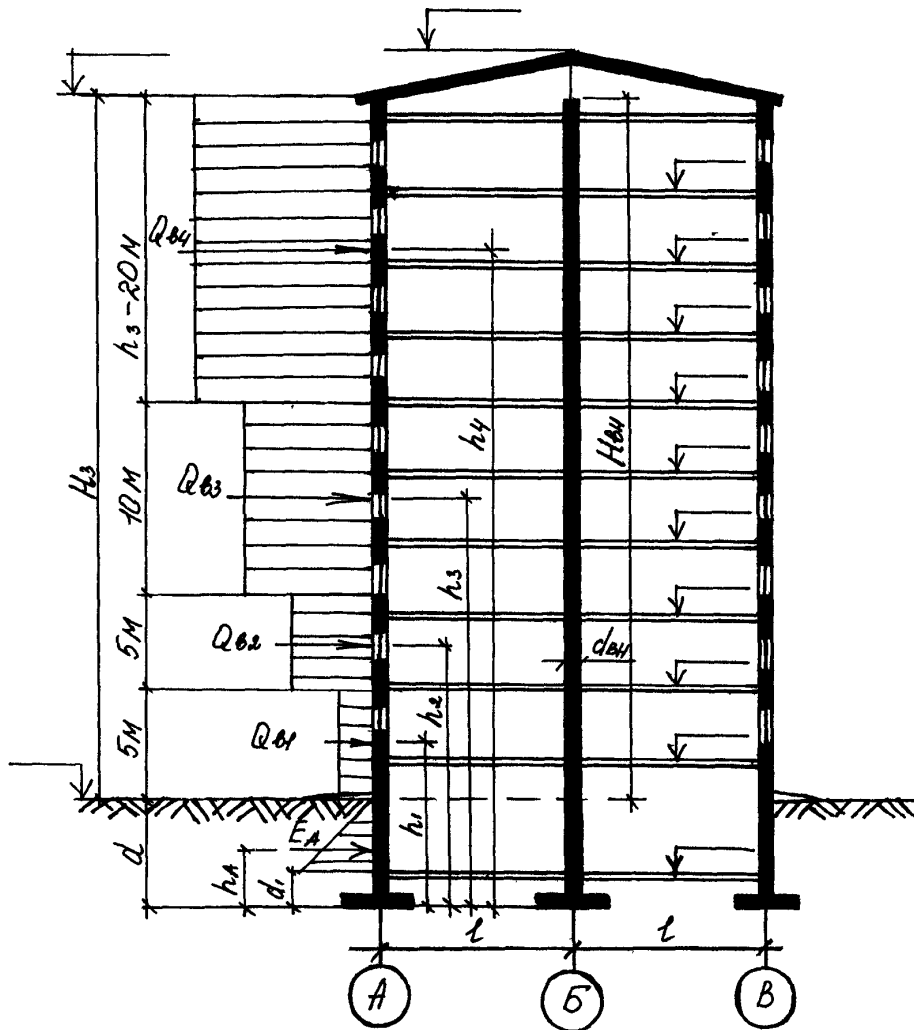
Схема до визначення навантажень на фундаменти
